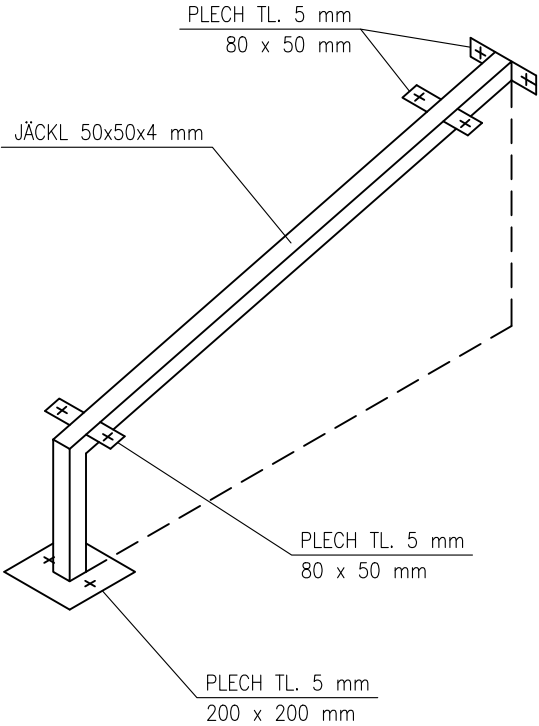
### DETAIL KOTEVNÍHO PRVKU, CELKEM 4 ks
